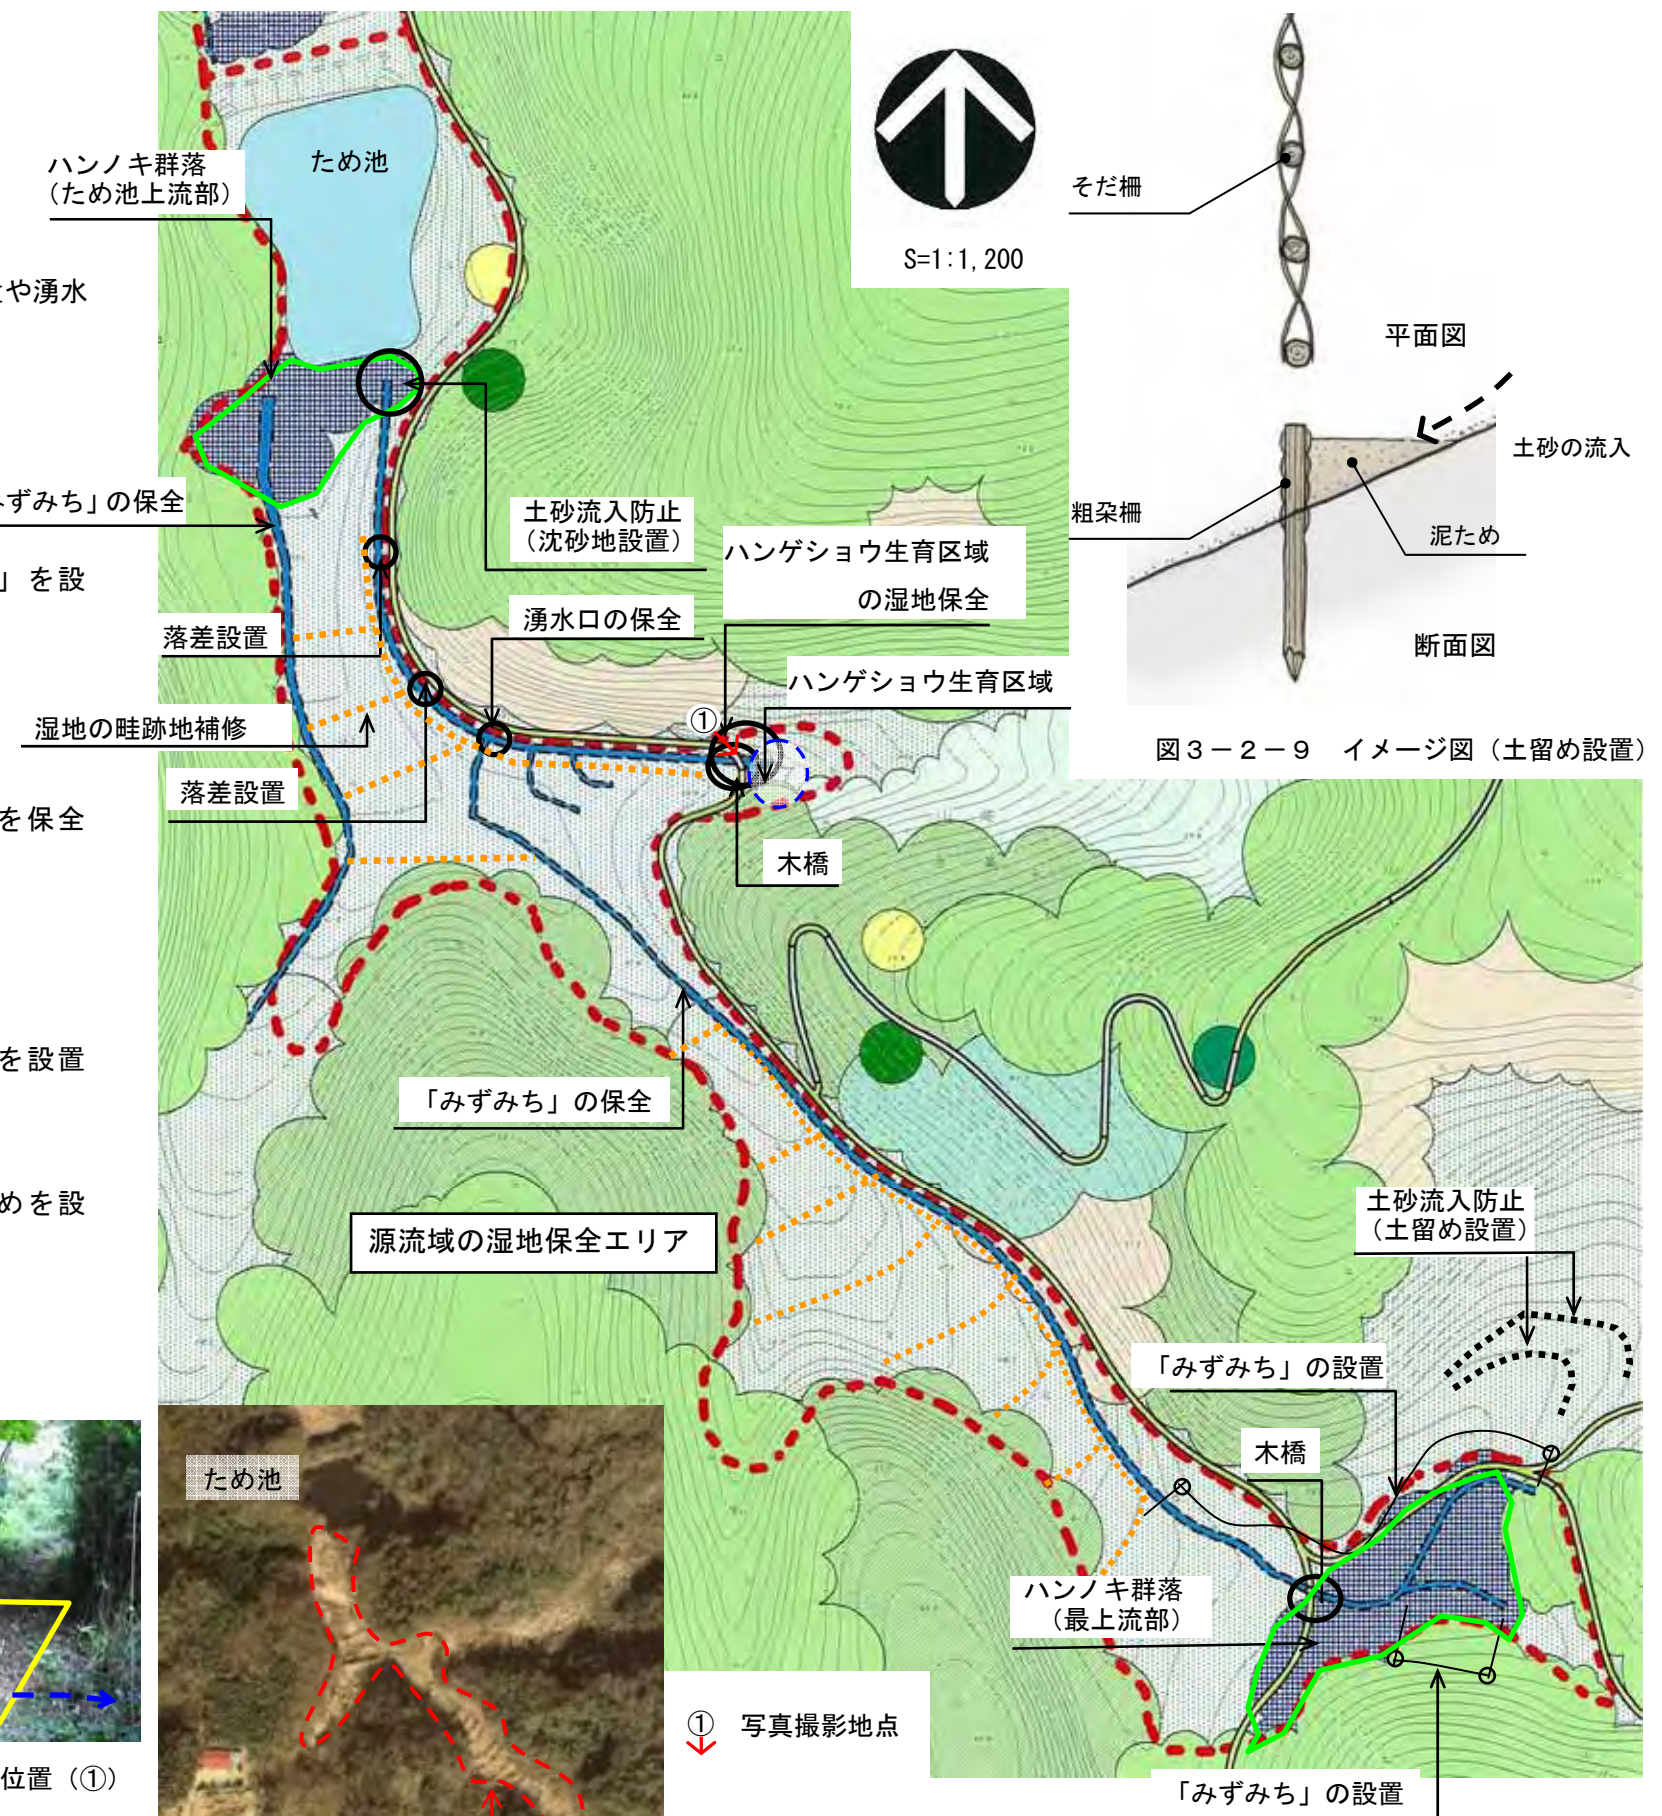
源流域の湿地保全エリア 基盤整備平面図
